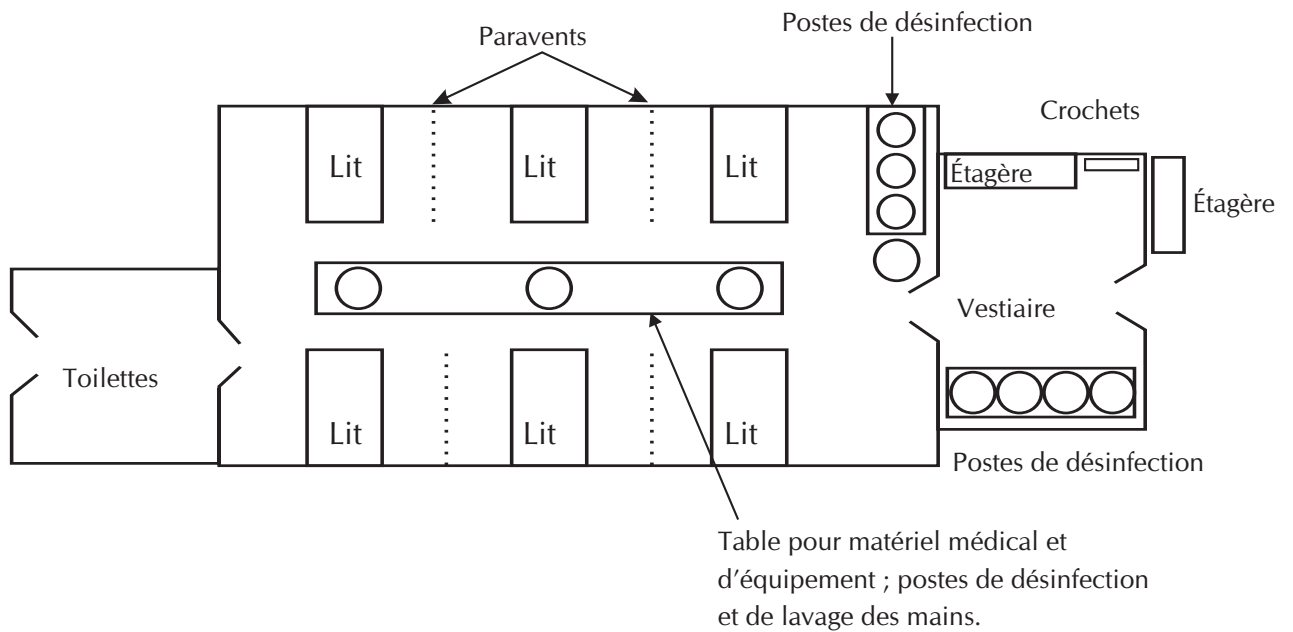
Plan d'une zone d'isolement pour plusieurs malades
